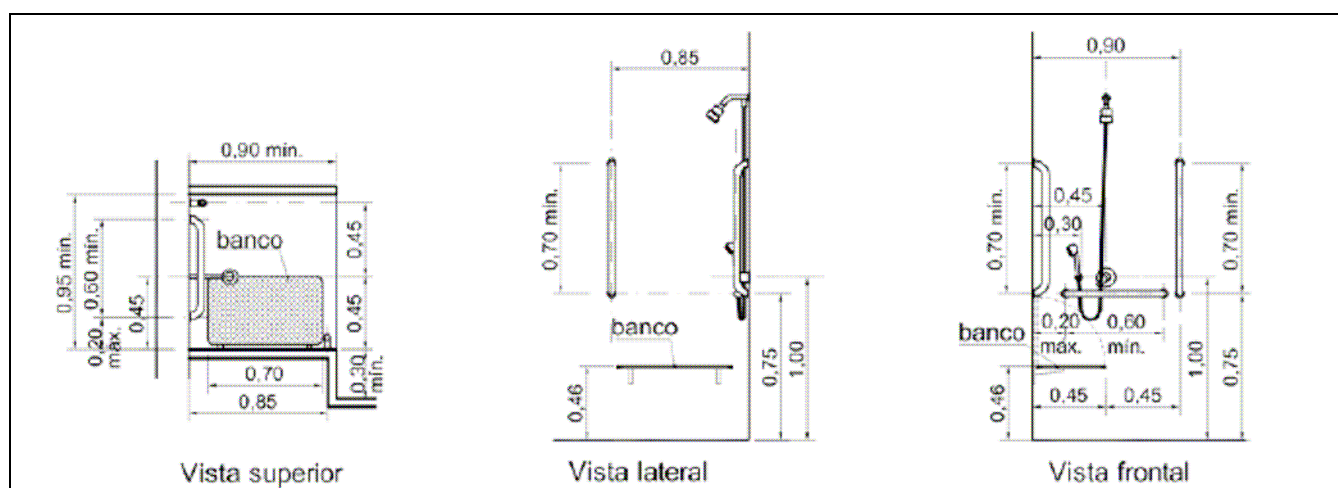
Boxe para chuveiro com barras de apoio vertical e horizontal (Figura 128 da NBR 9050).
